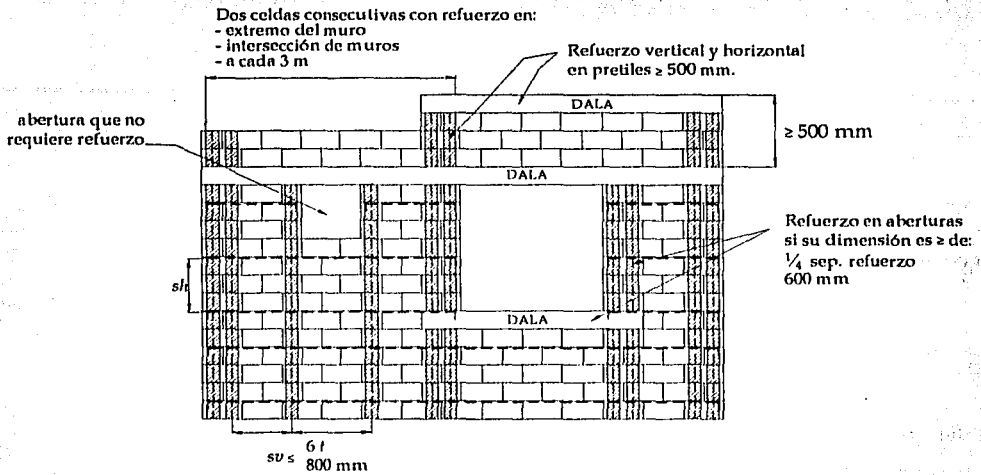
Requisitos para mampostería con refuerzo interior.
